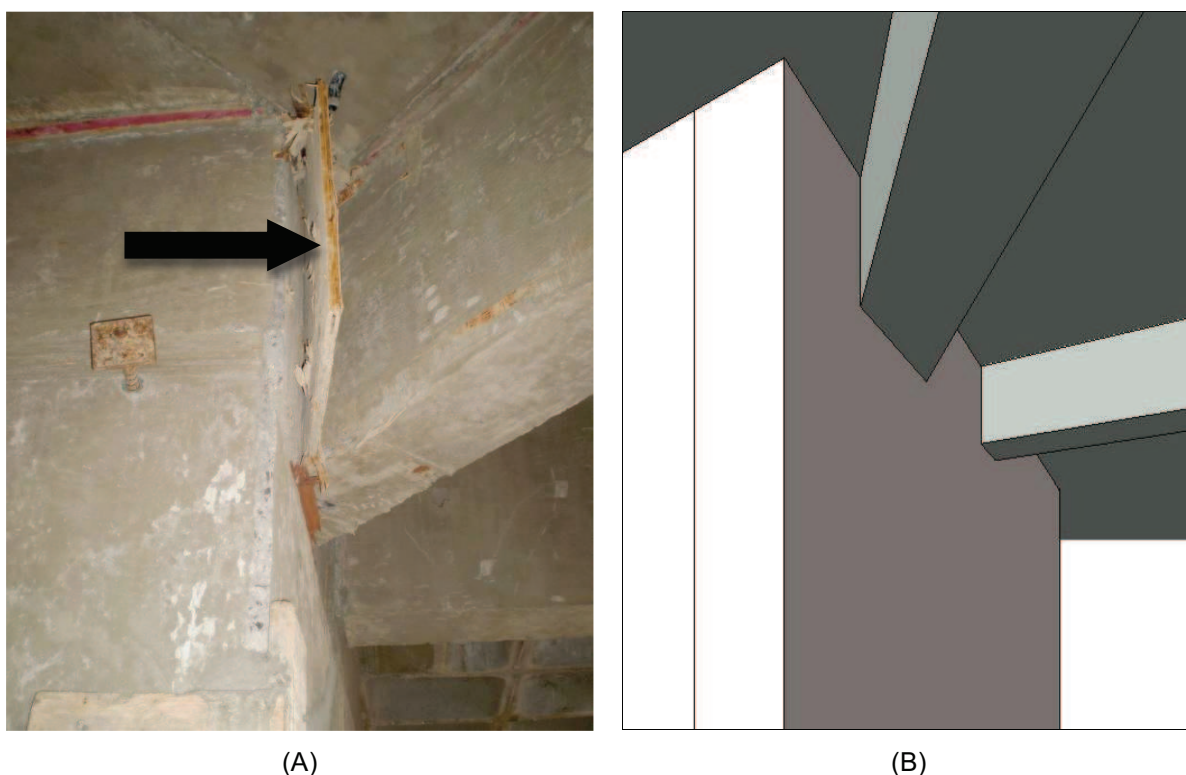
(A) Foto da Viga e Pilar do elevador. (B) Simulação 3D do detalhe (A)
